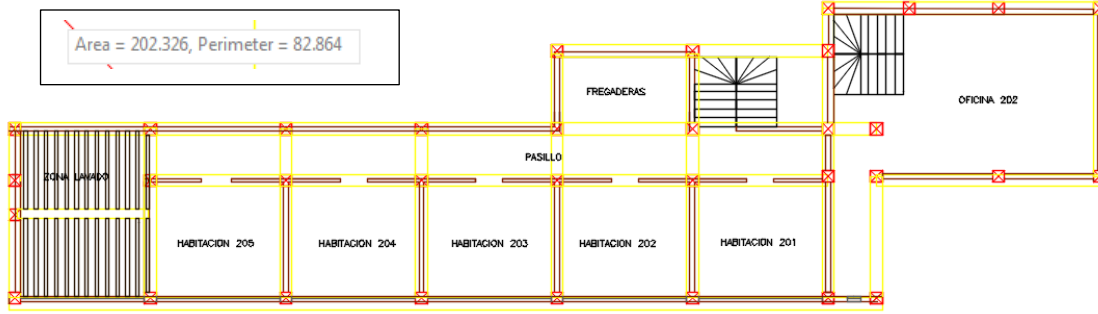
Dibujo AutoCAD vista planta (Primer piso).
